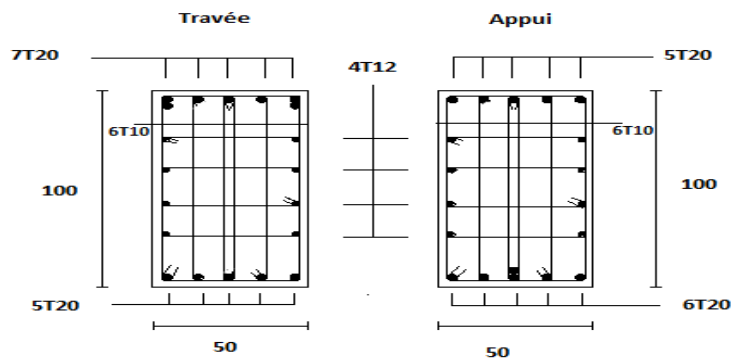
Ferrailage de la nervure sens Y-Y.
